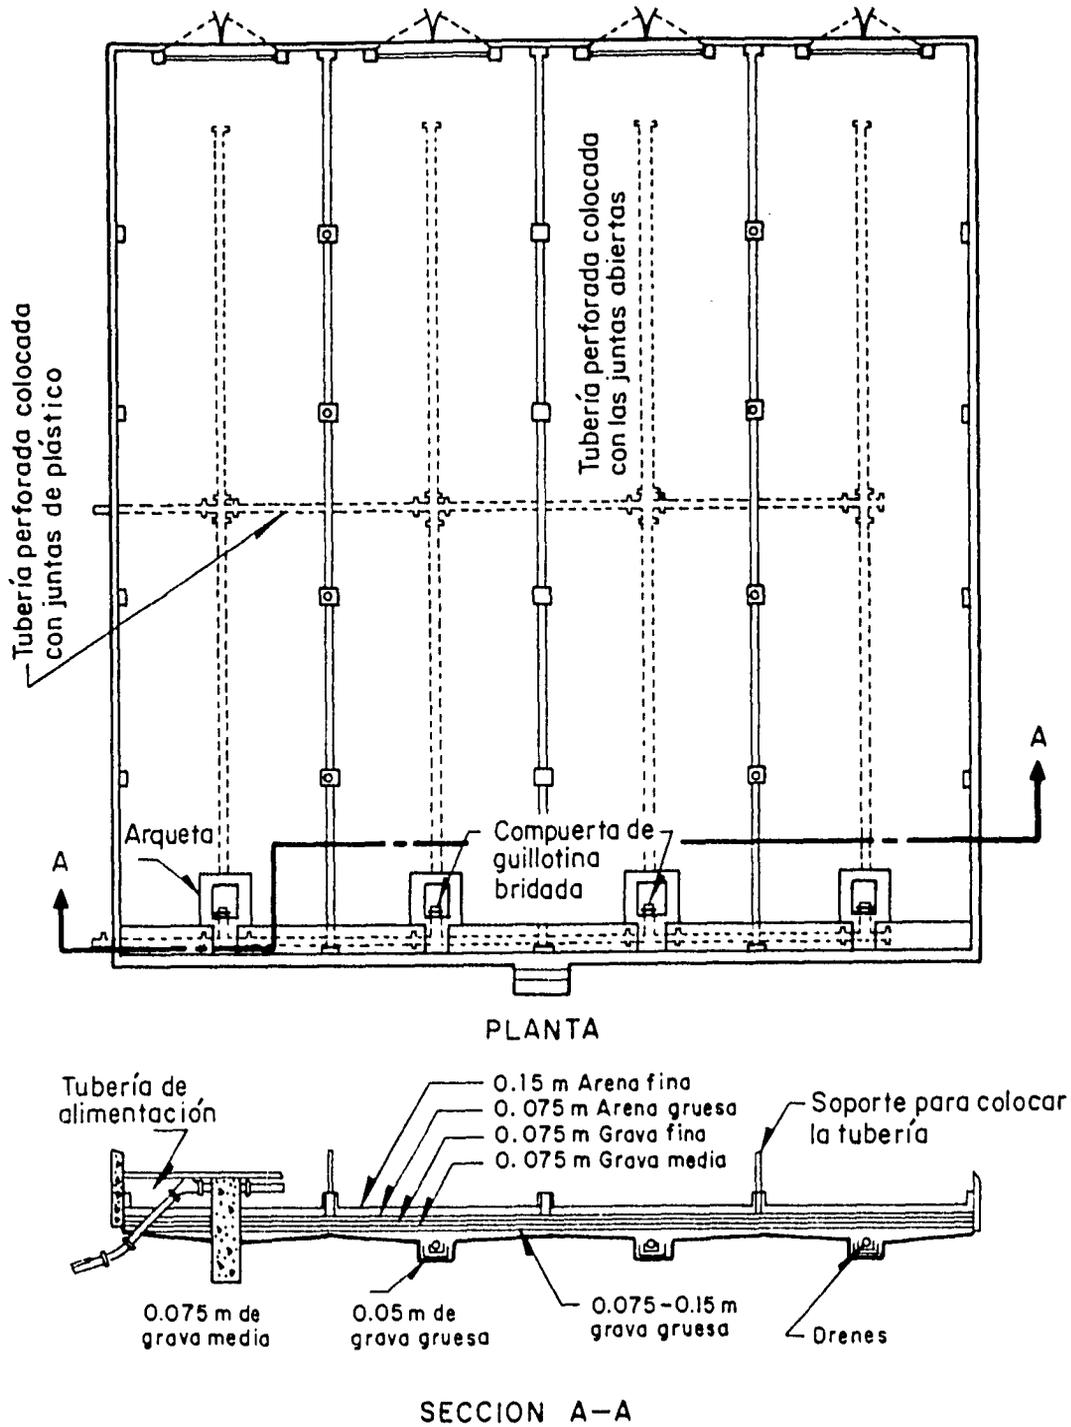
Planta y corte de la estructura de soporte y sistemas para recolección de escurrimientos en un lecho de secado típico
